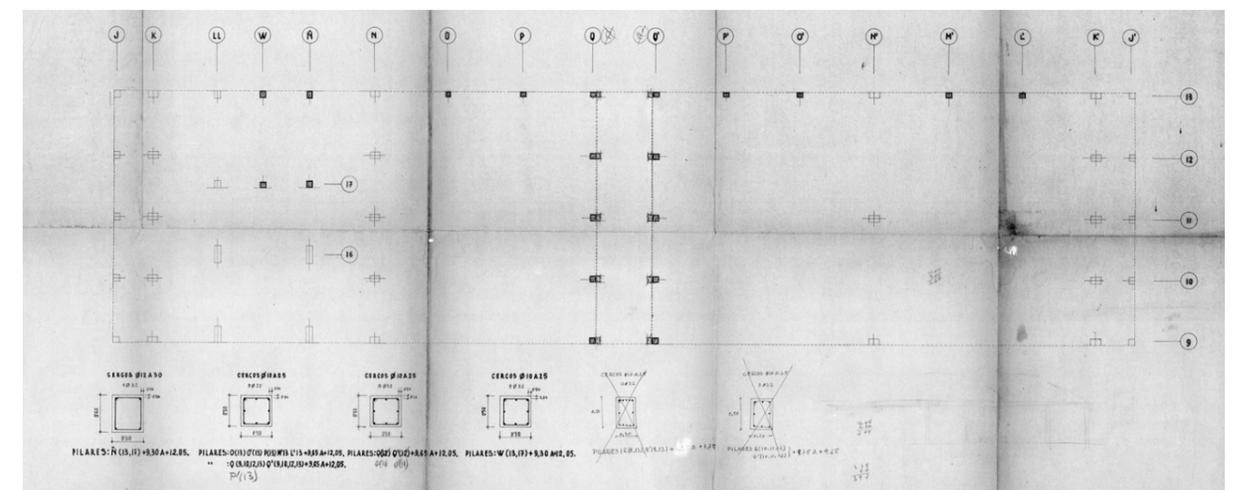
Disposición de pilares en planta baja y detalle individualizado de los pilares y sus armaduras
